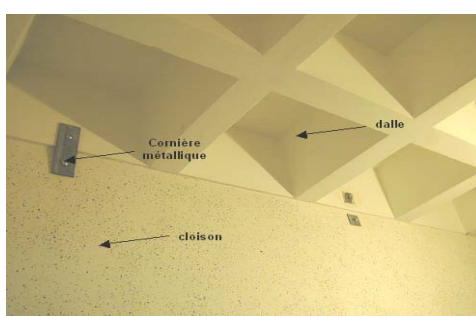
Exemple de solidarisation d'une cloison à un plancher haut à l'aide de plats métalliques (Source : CETE Méditerranée)
